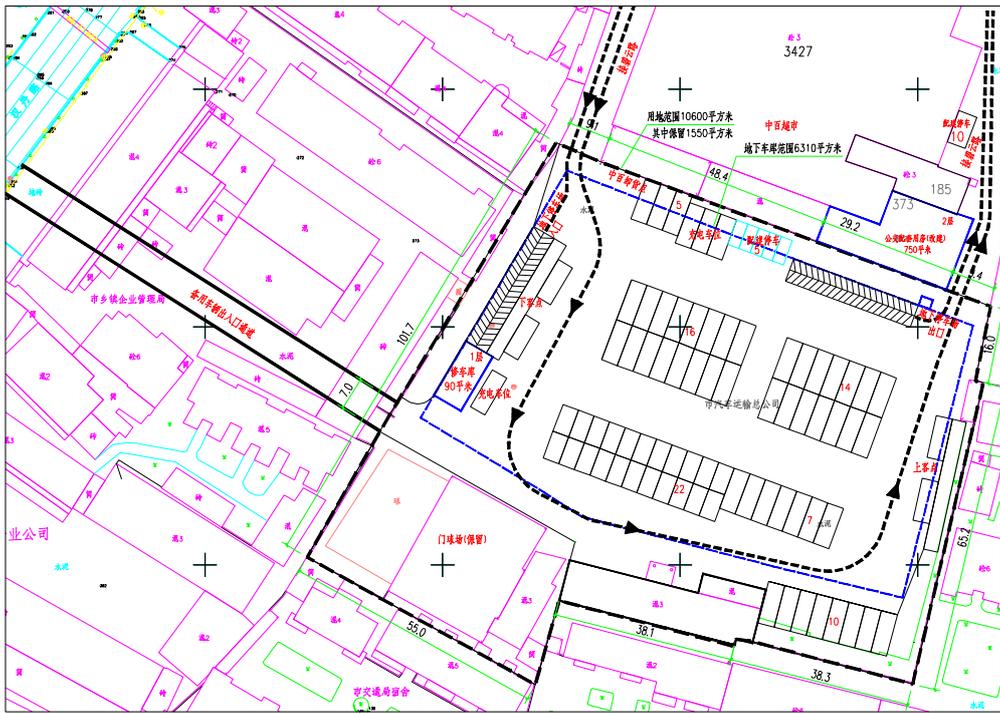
短途站交通枢纽平面布局示意图
